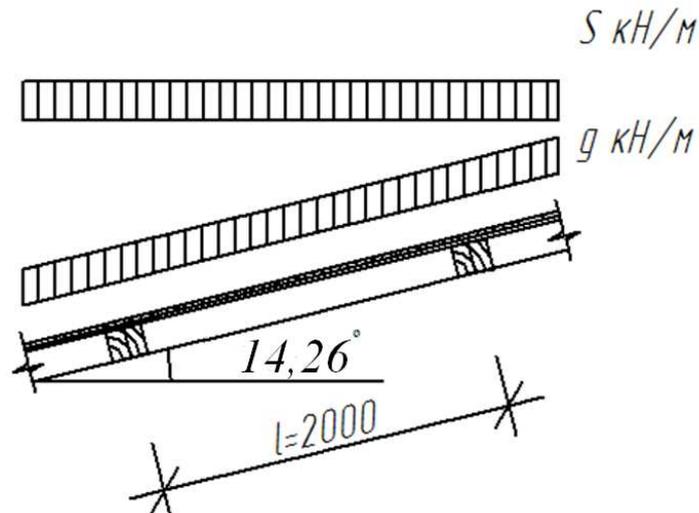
К расчету на первое сочетание нагрузок.
